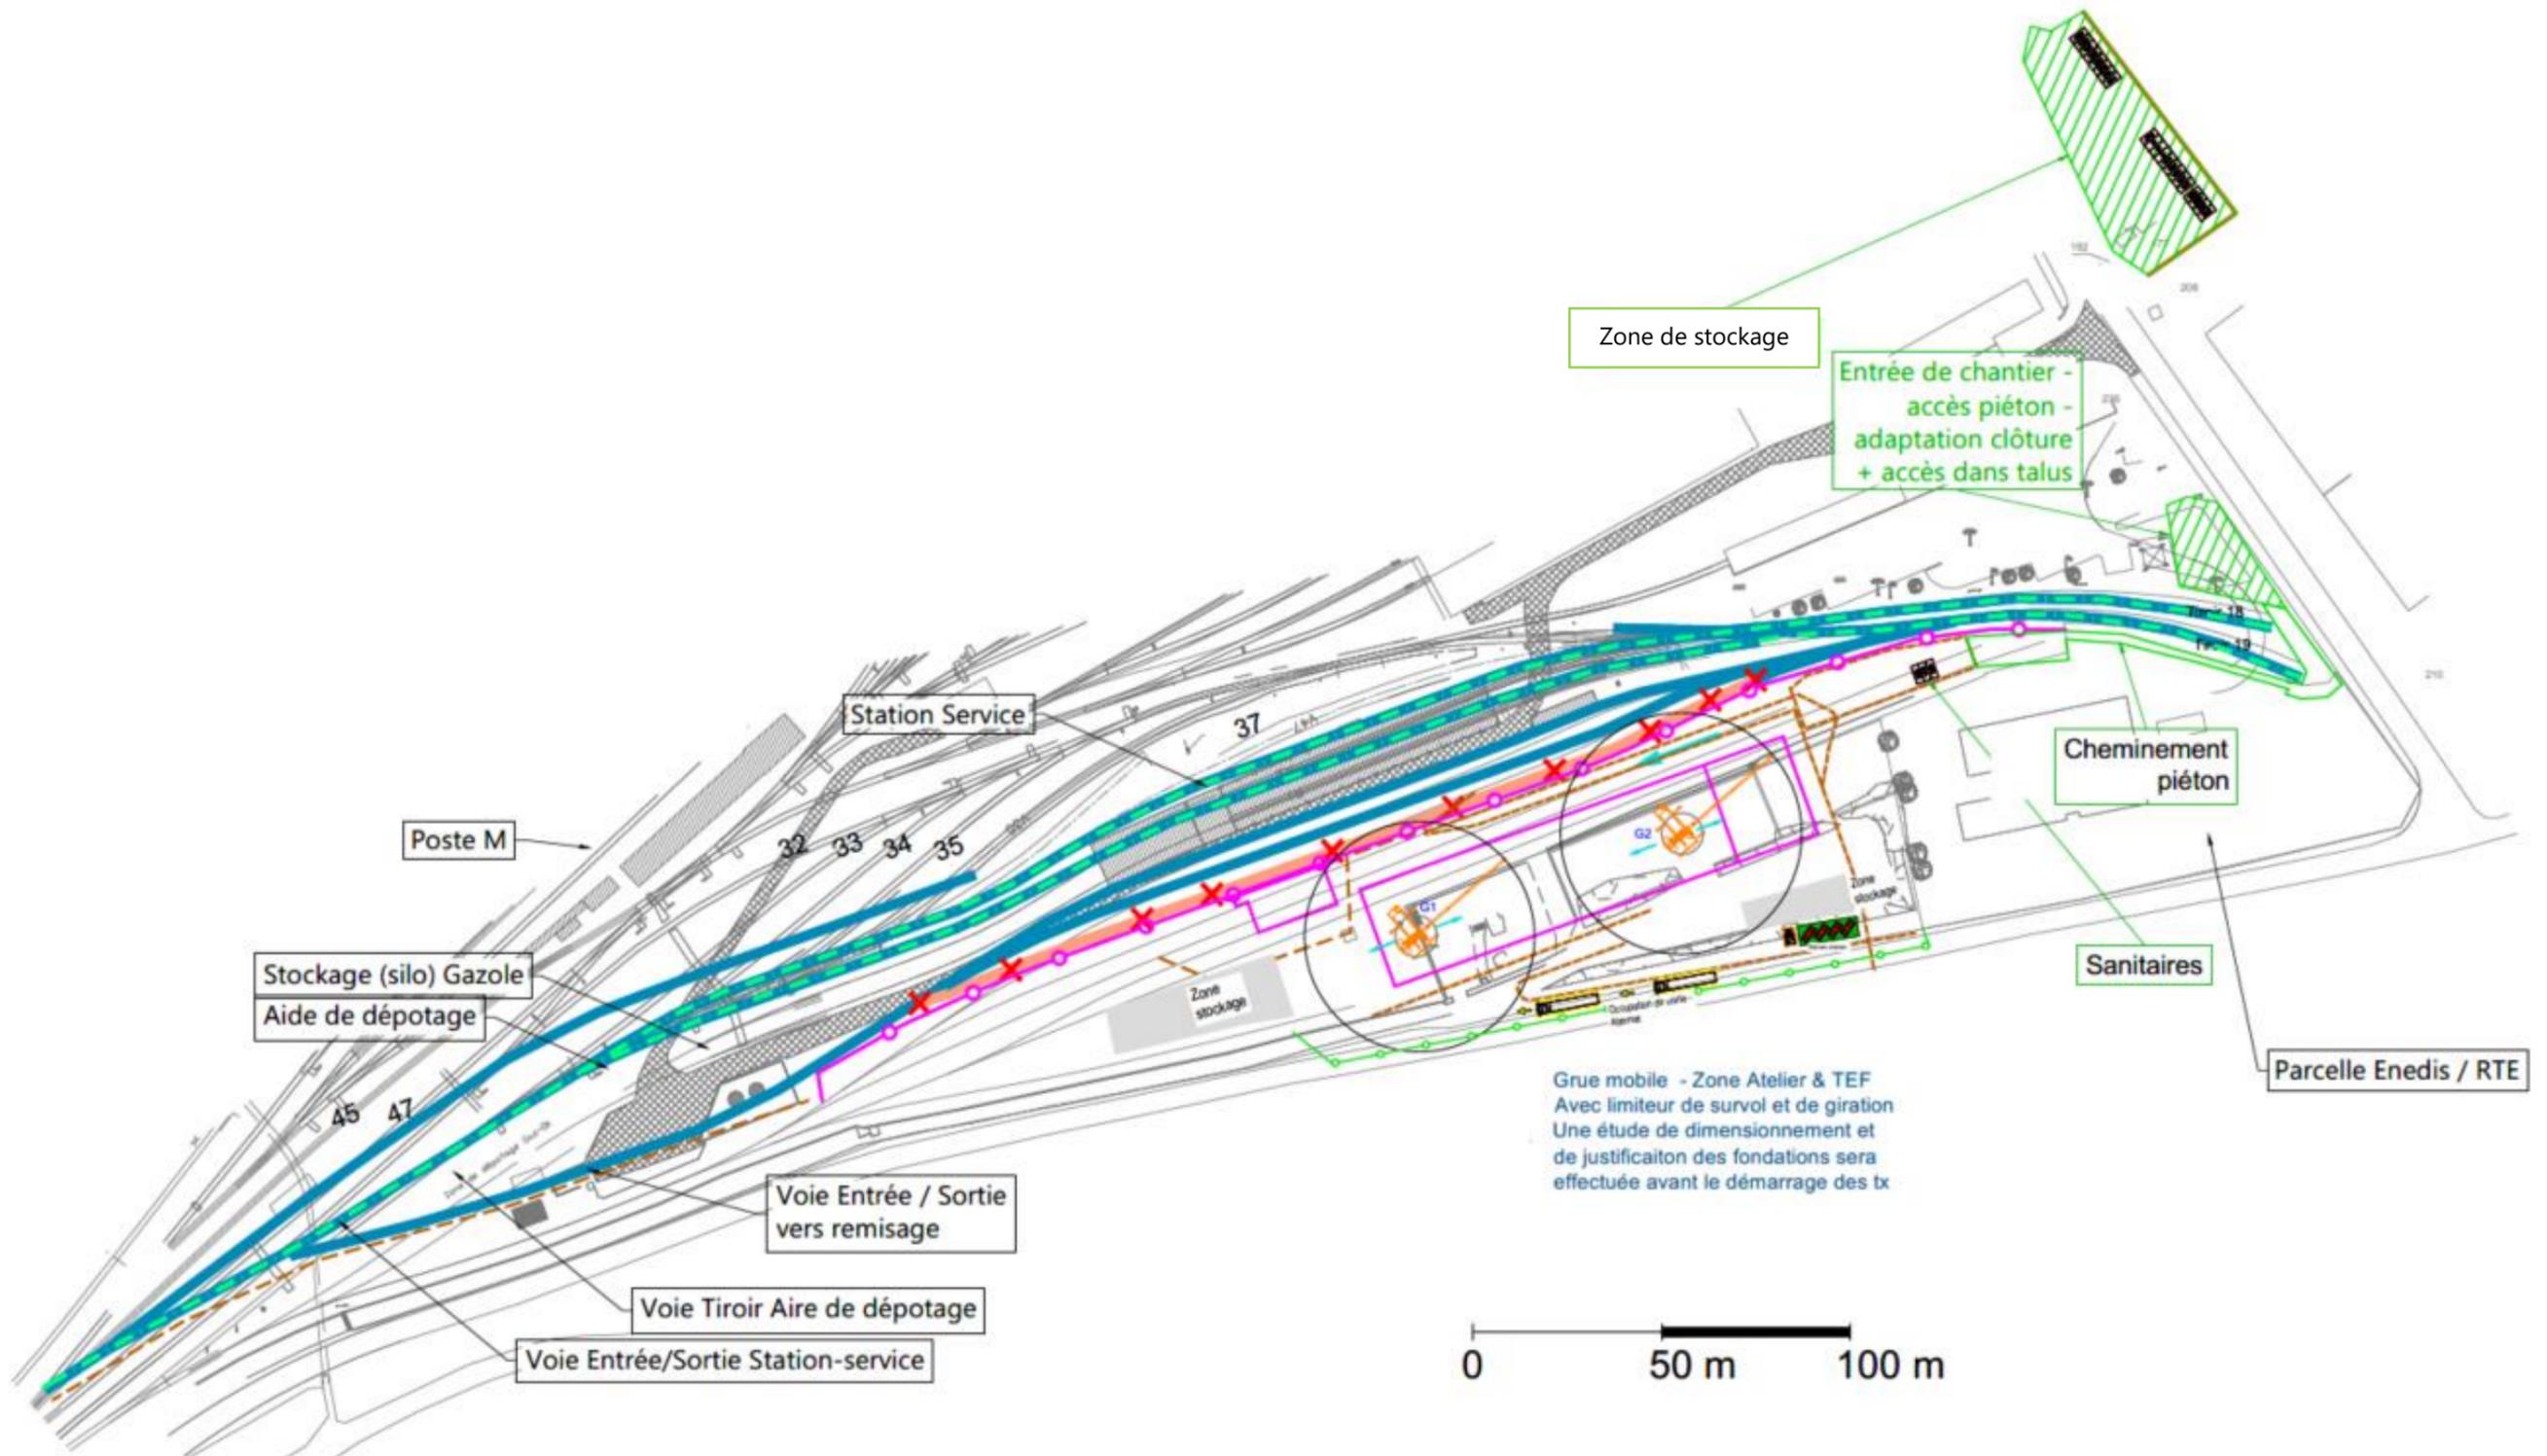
PLAN D'INSTALLATION DE CHANTIER (SOURCE : DOSSIER PRO)
